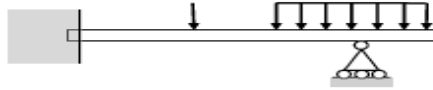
Cas d'une Poutre avec Porte à Faux
